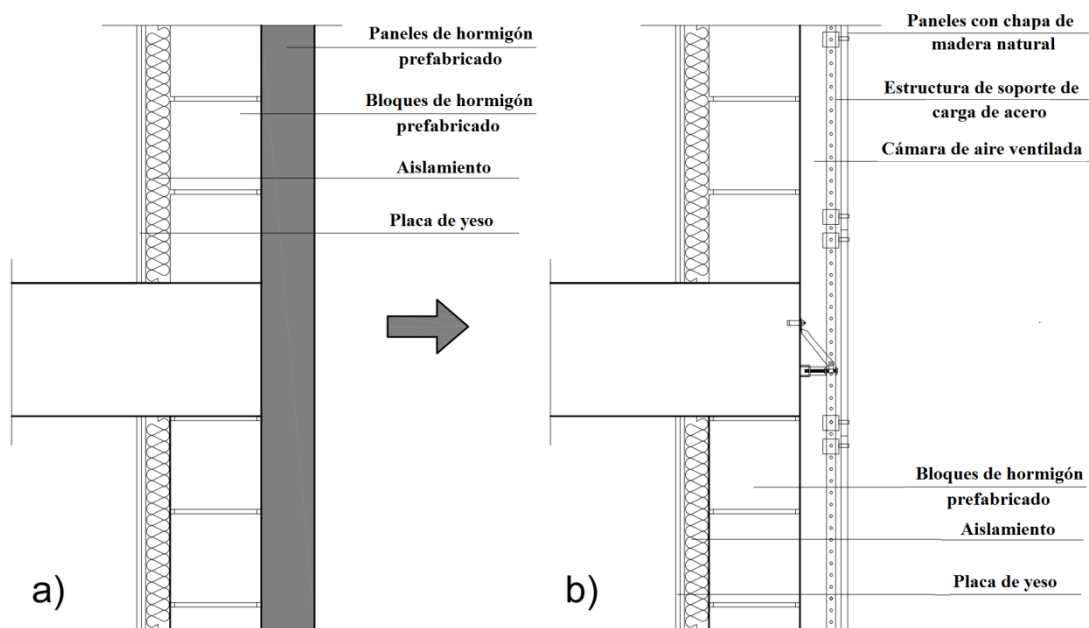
Sección de la fachada original del edificio y de la fachada ventilada propuesta.
